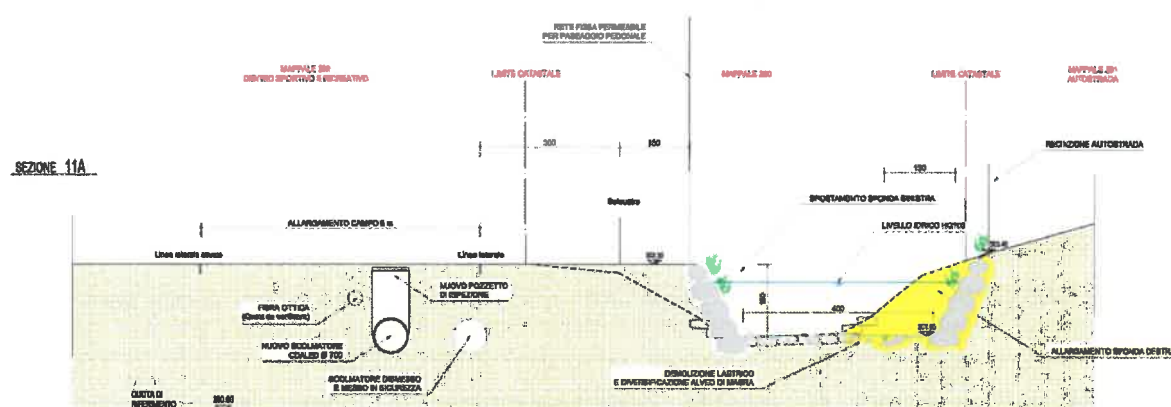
sezione riale nel punto più stretto - angolo campo di calcio
